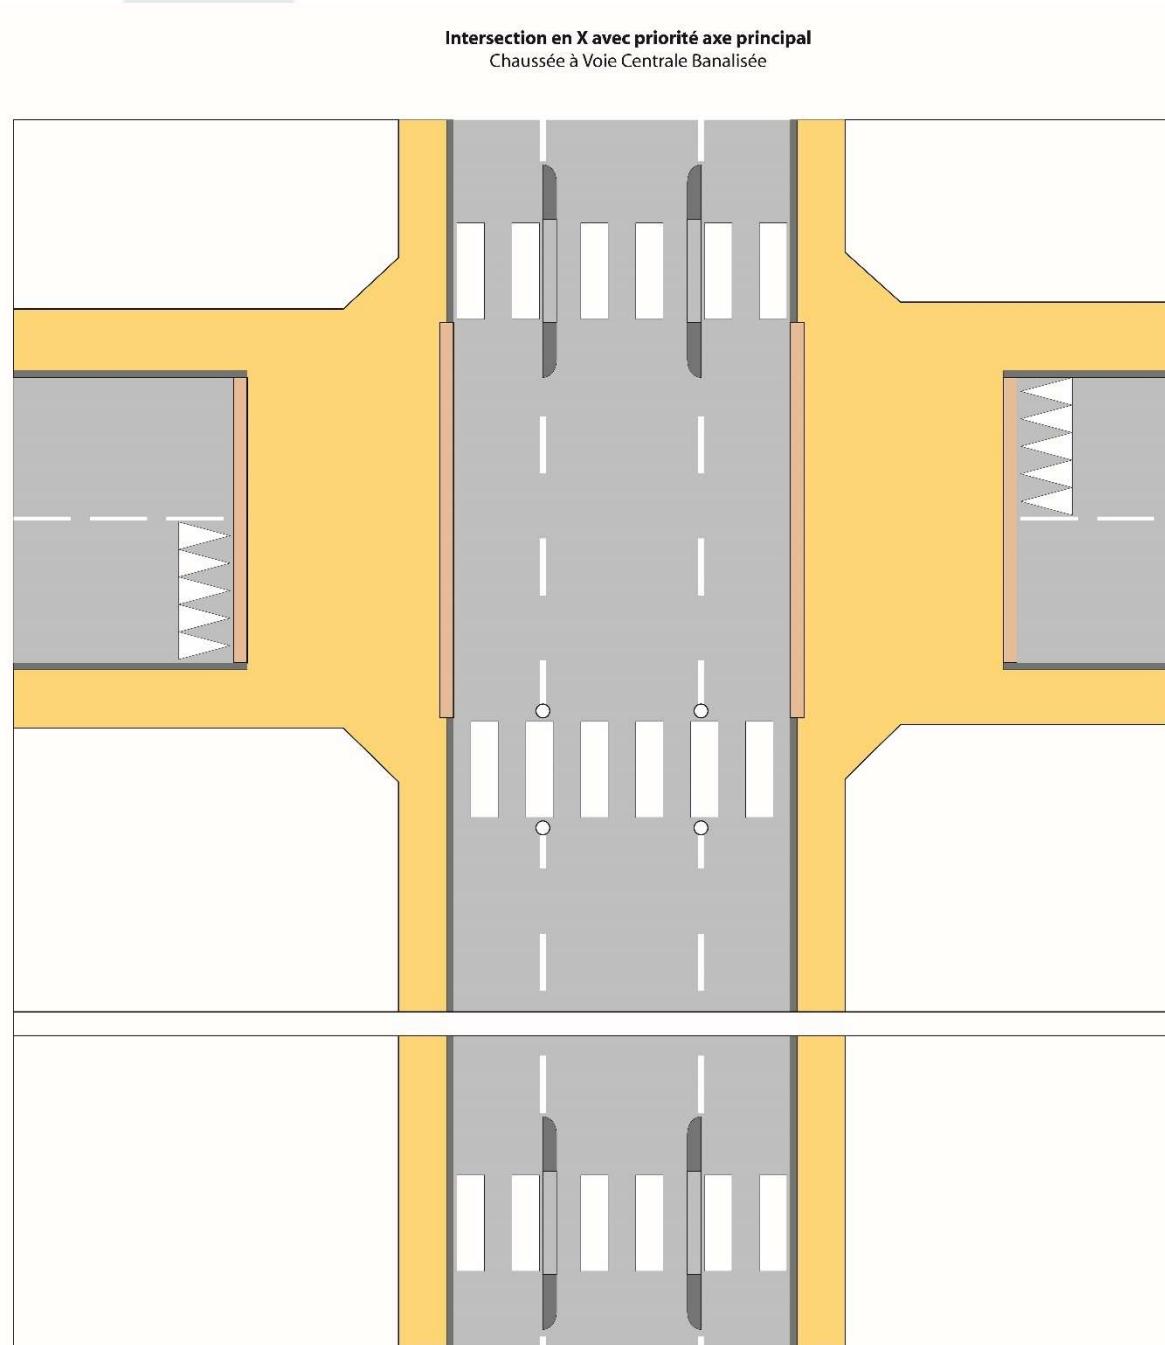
Traitement d'une intersection en x avec priorité - chaussée à voie centrale banalisée
